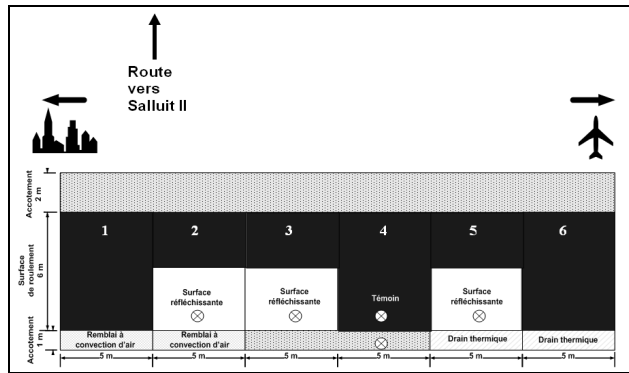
Vue en plan du site d'essais sur la route d'accès à Salluit (Doré et Voyer, 2010)
